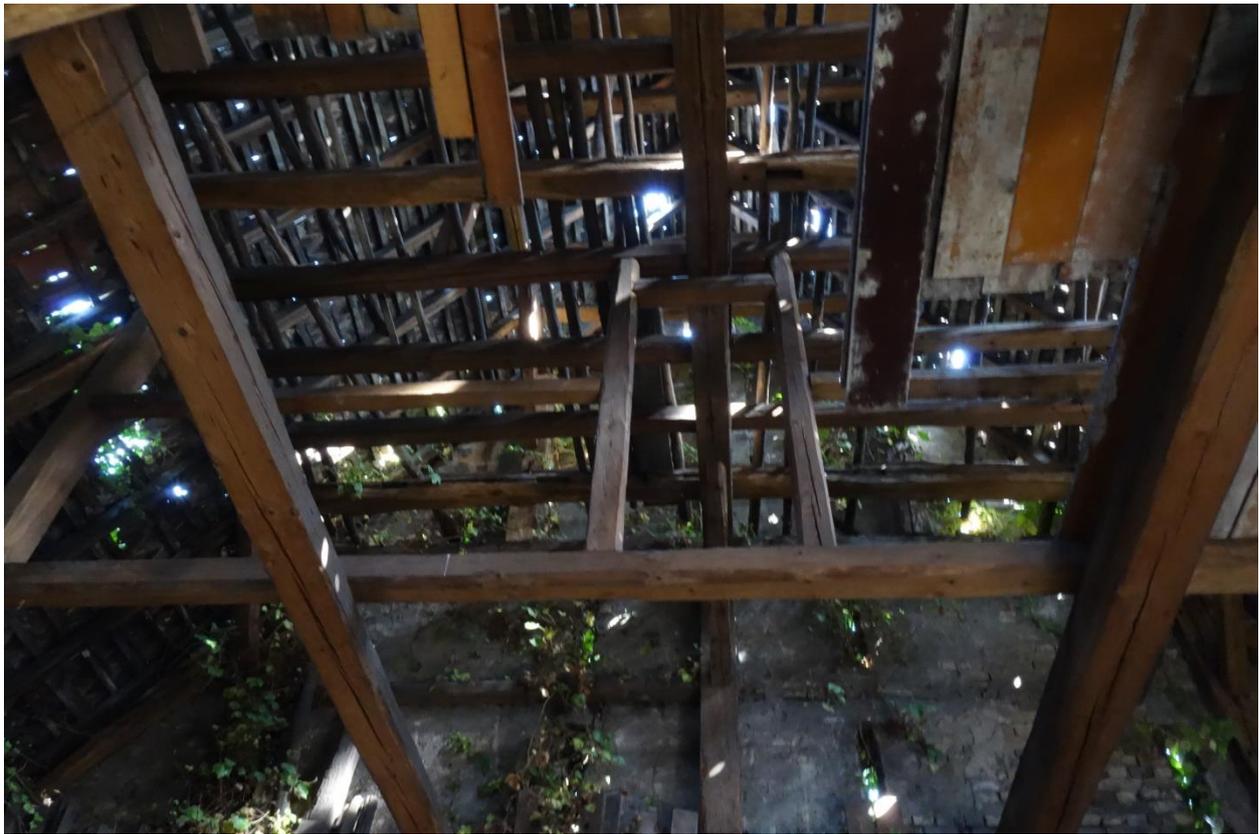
Dach der Scheune Wilhelmstraße Nr. 33
